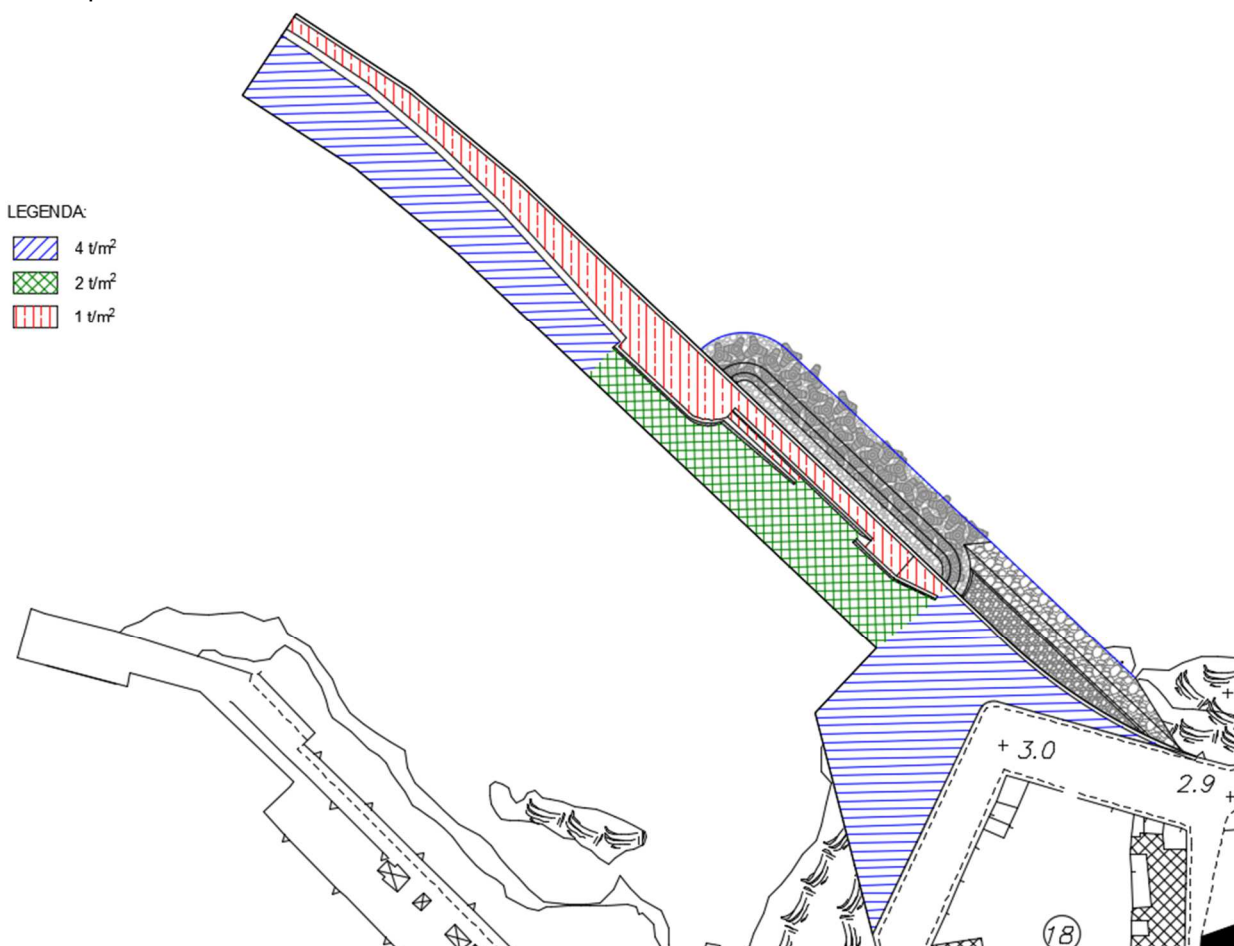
Planimetria con indicazione dei sovraccarichi di progetto
